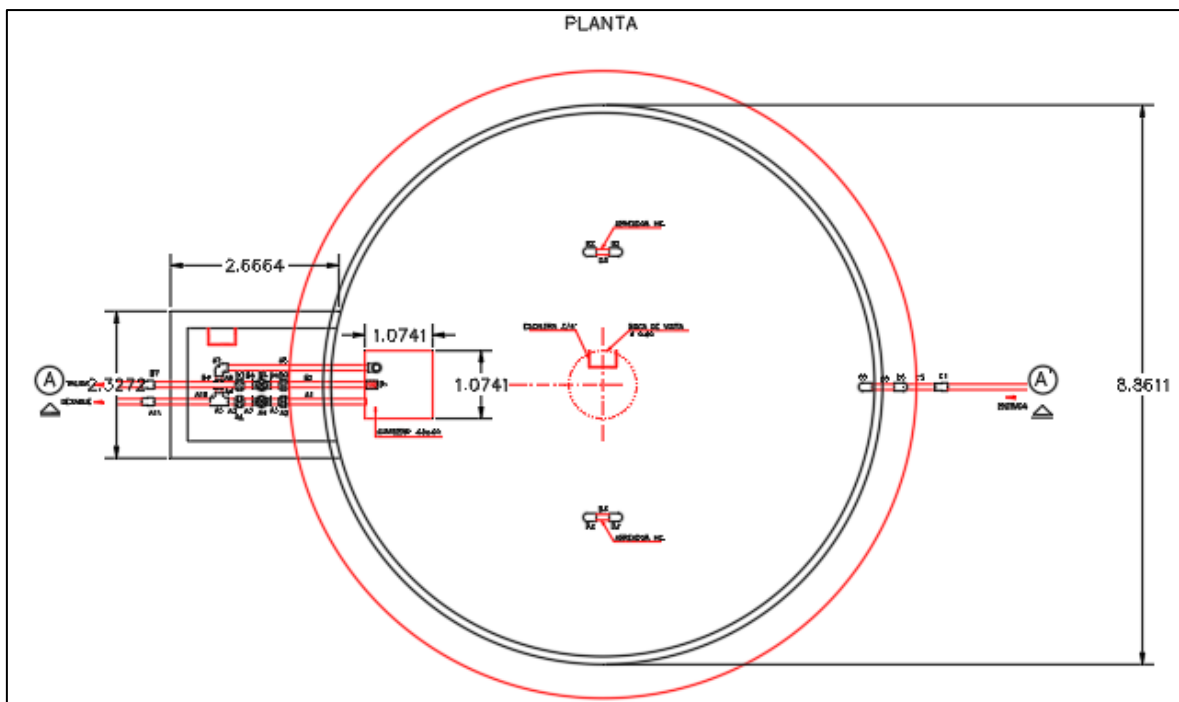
Planteamiento de mejora – Tanque de almacenamiento principal vista planta
